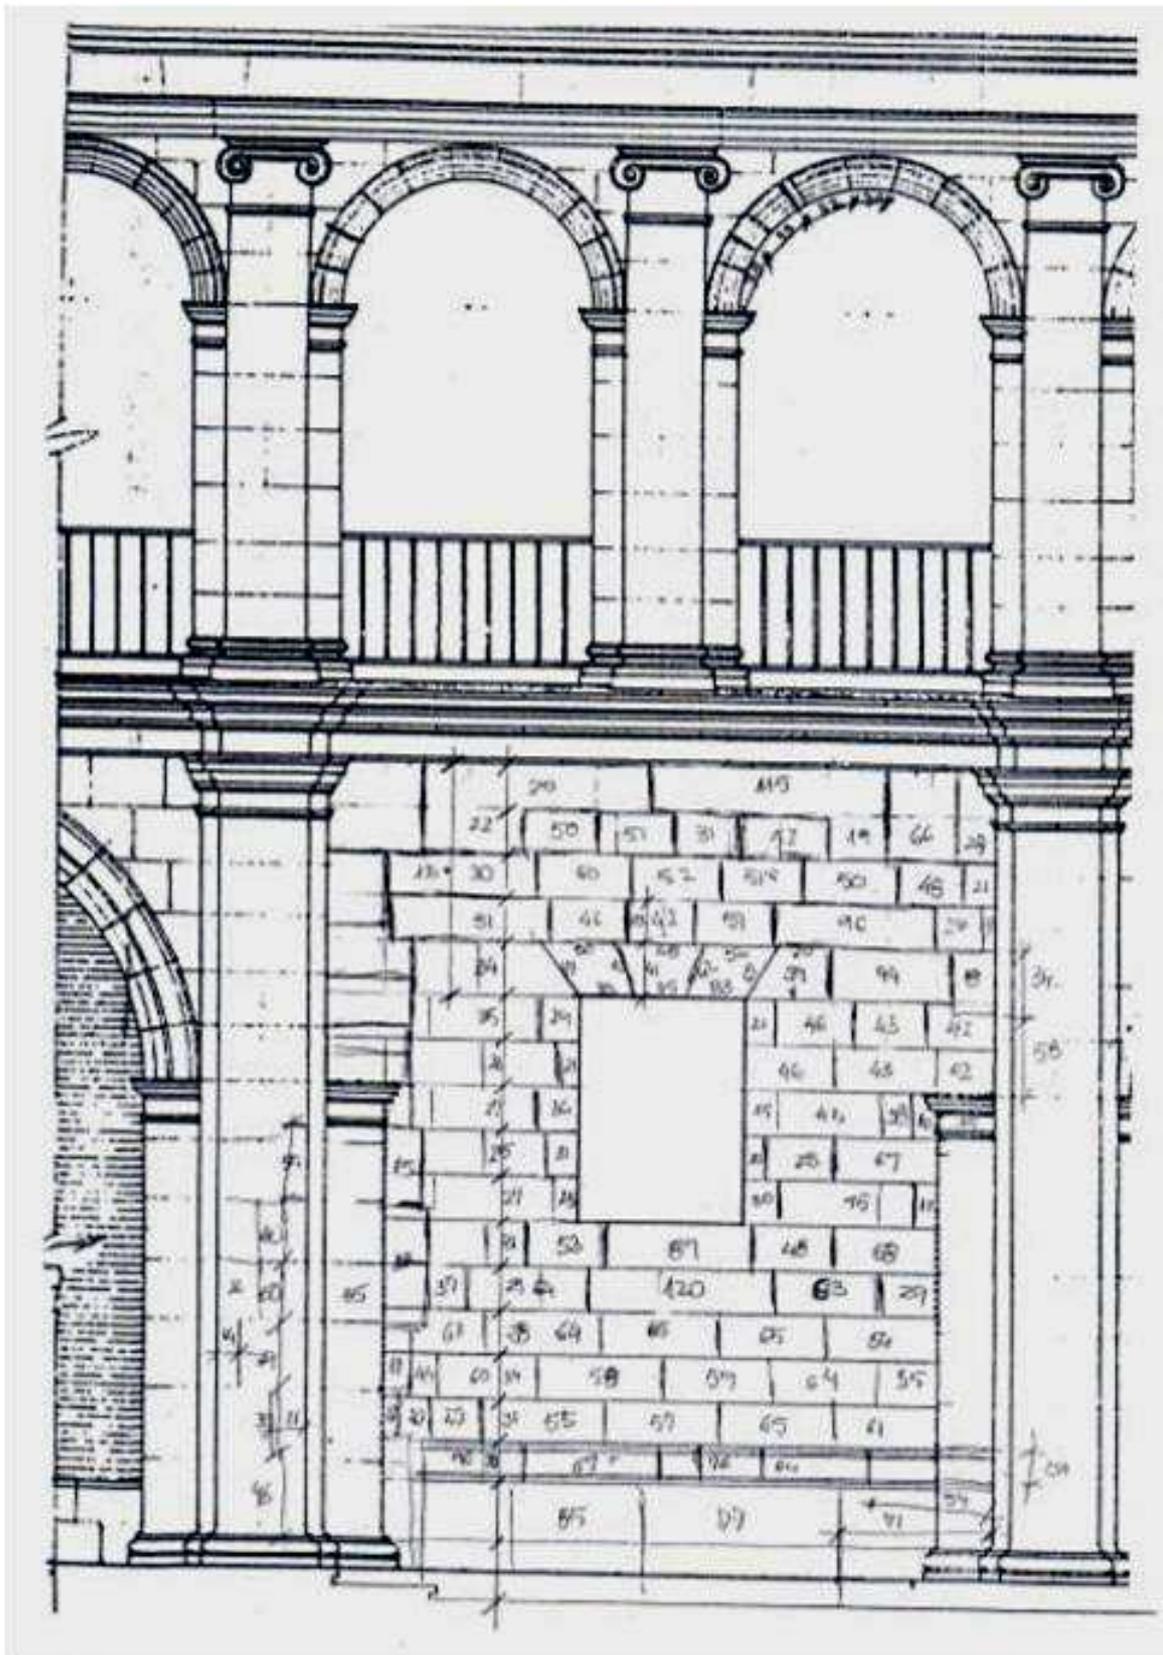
24.4 Toma de datos del despiece de sillares y pilastras del tramo recto de planta baja.
